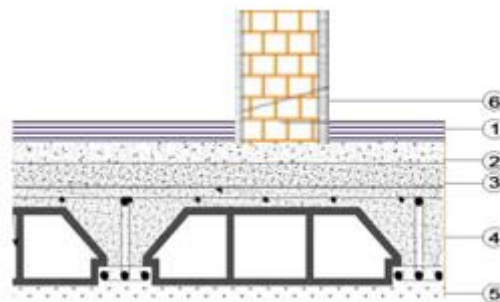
Coupe verticale d'un plancher terrasse inaccessible.
